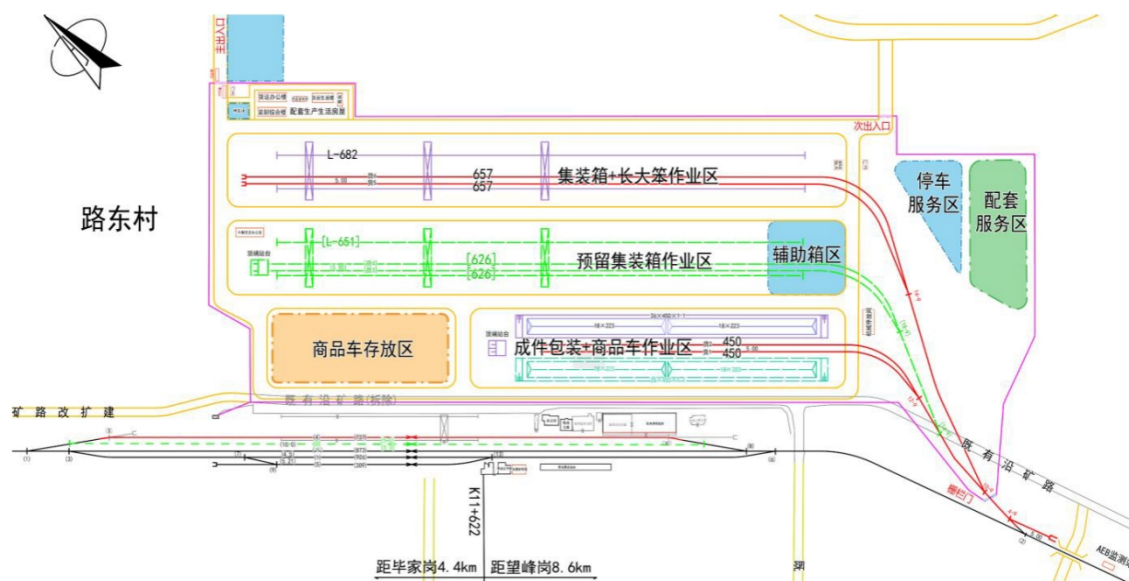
多式联运基地平面布置图（接轨方案I-1）
